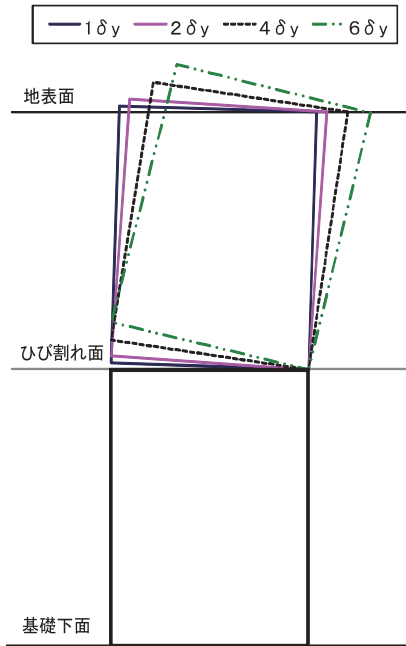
ひび割れ位置でのケーソンの挙動（橋軸方向荷重）
